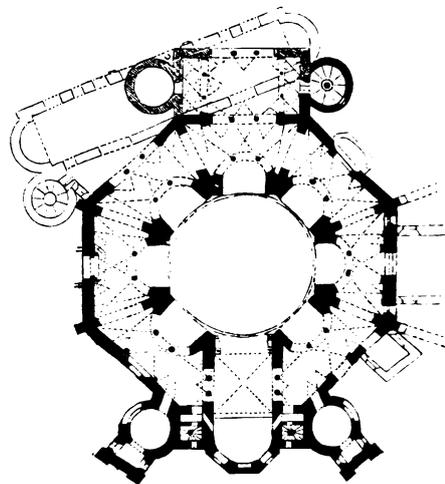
Grundriss von San Vitale in Ravenna.
